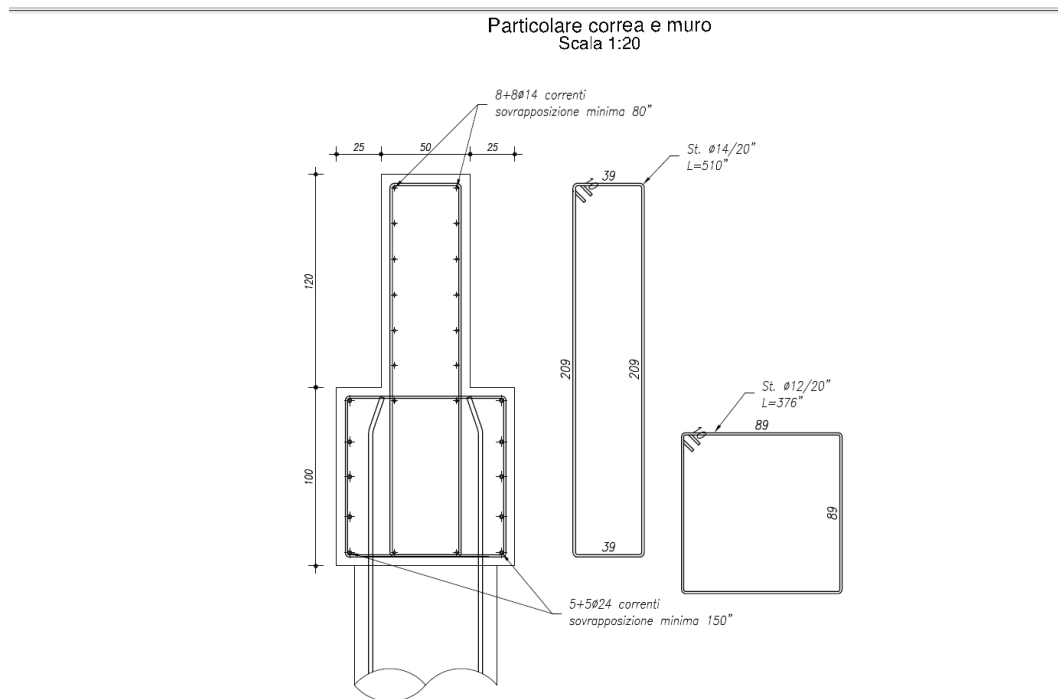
Sezione tipo del cordolo e del muretto dell'opera di consolidamento
